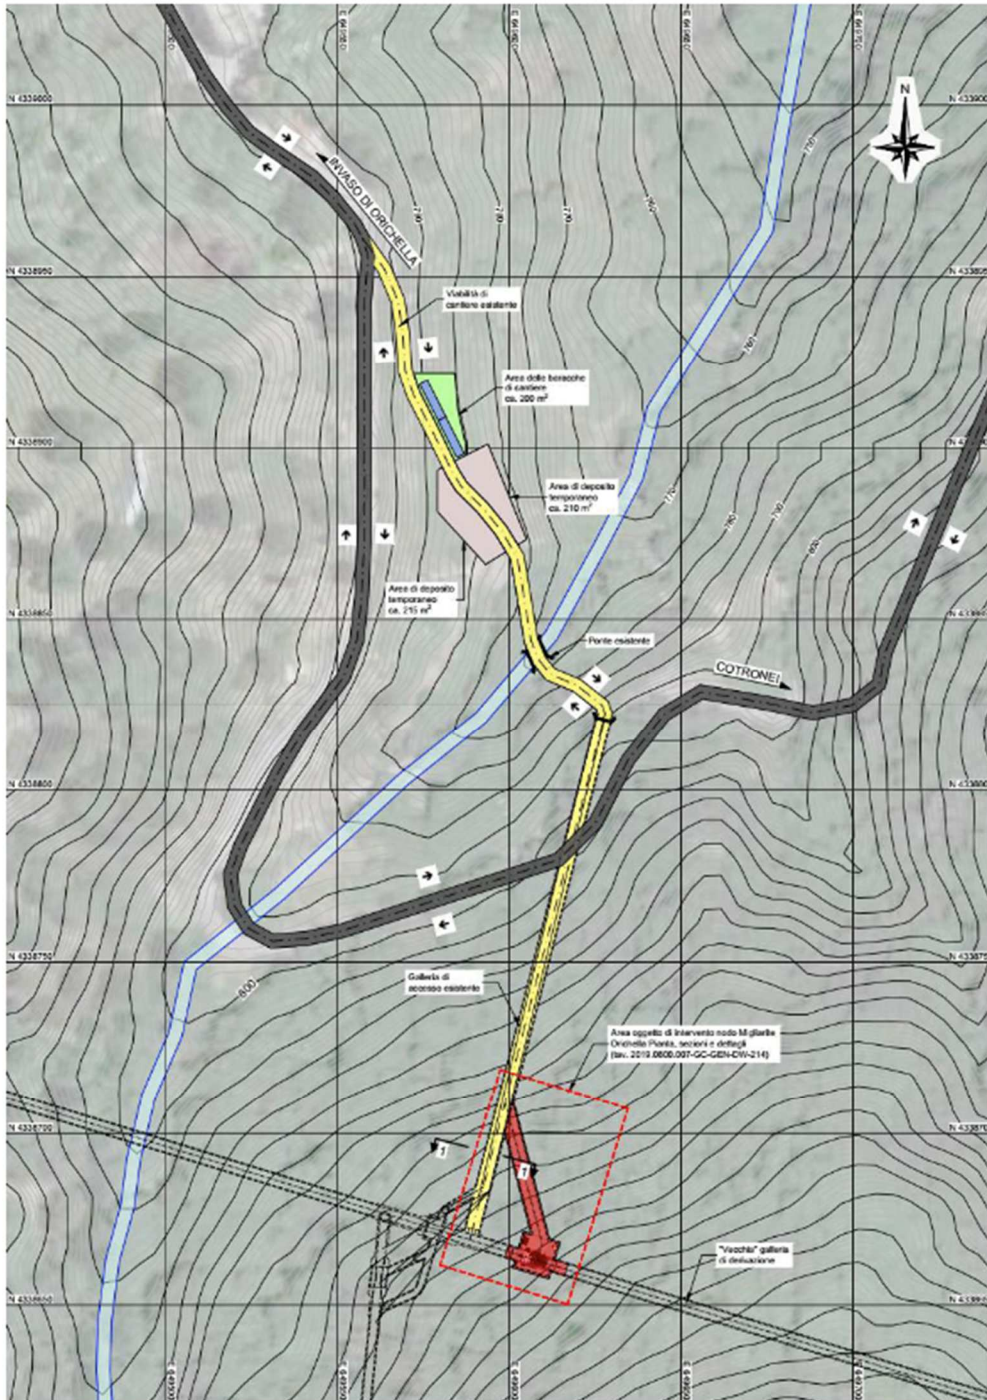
Nodo di Migliarite-Orichella, planimetria di cantiere [82].
